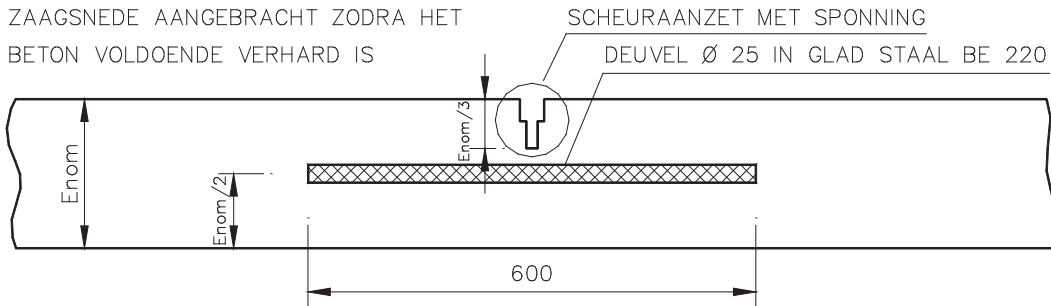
Detail van de dwarse uitzettingsvoeg (alle maten in mm)
